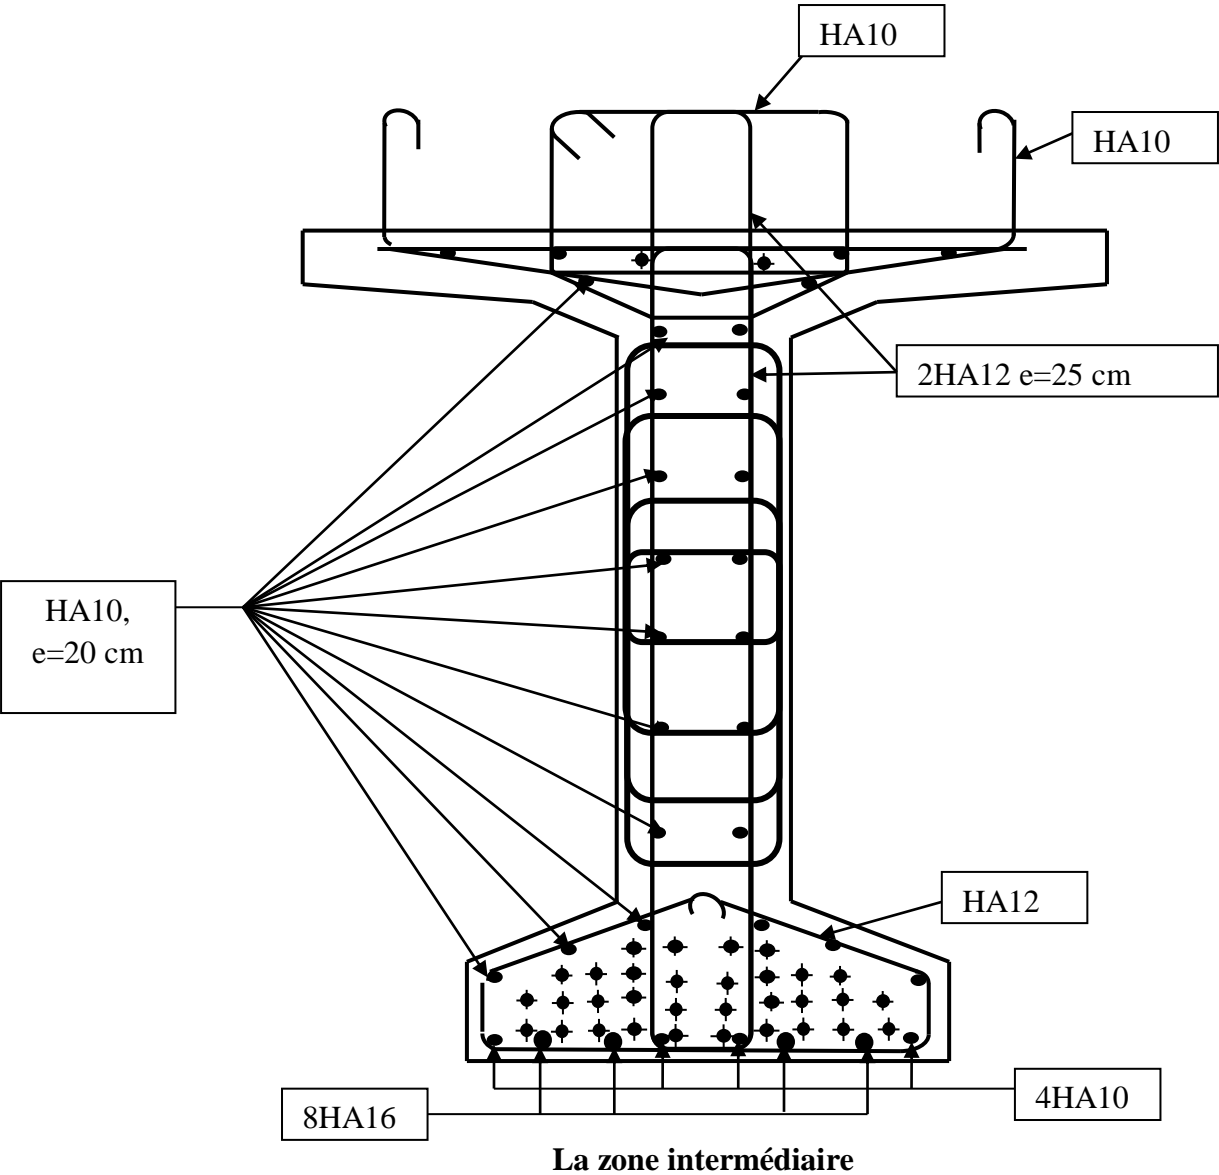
Ferrailage de la poutre zone intermédiaire
